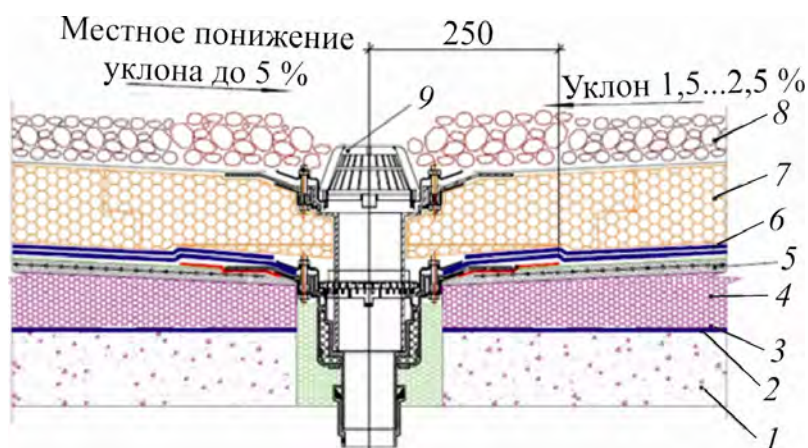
Узел примыкания воронки: 1 — плита перекрытия; 2 — грунтовочный слой; 3 — пароизоляция; 4 — утеплитель существующей крыши; 5 — армированная стяжка; 6 — восстановленный гидроизоляционный ковер; 7 — гравийная засыпка; 8 — гравий; 9 — водосточная воронка
